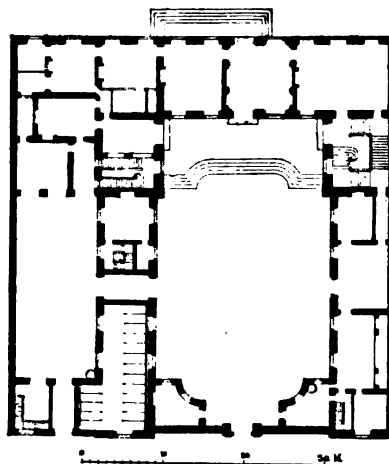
Grundriss des Hotels Chevreuse
